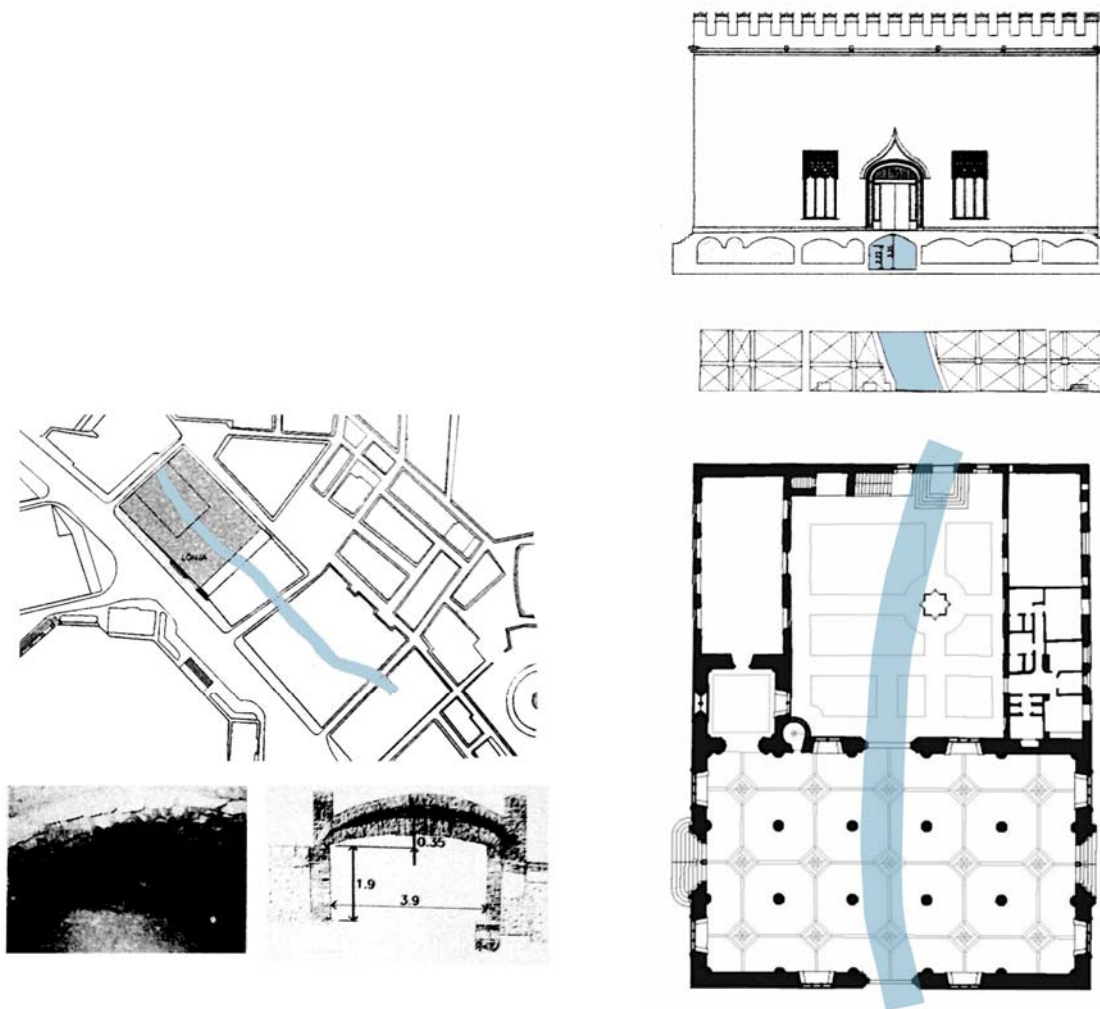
Alzado sección plano fotos y detalle cajero bajo la lonja de la Seda.
